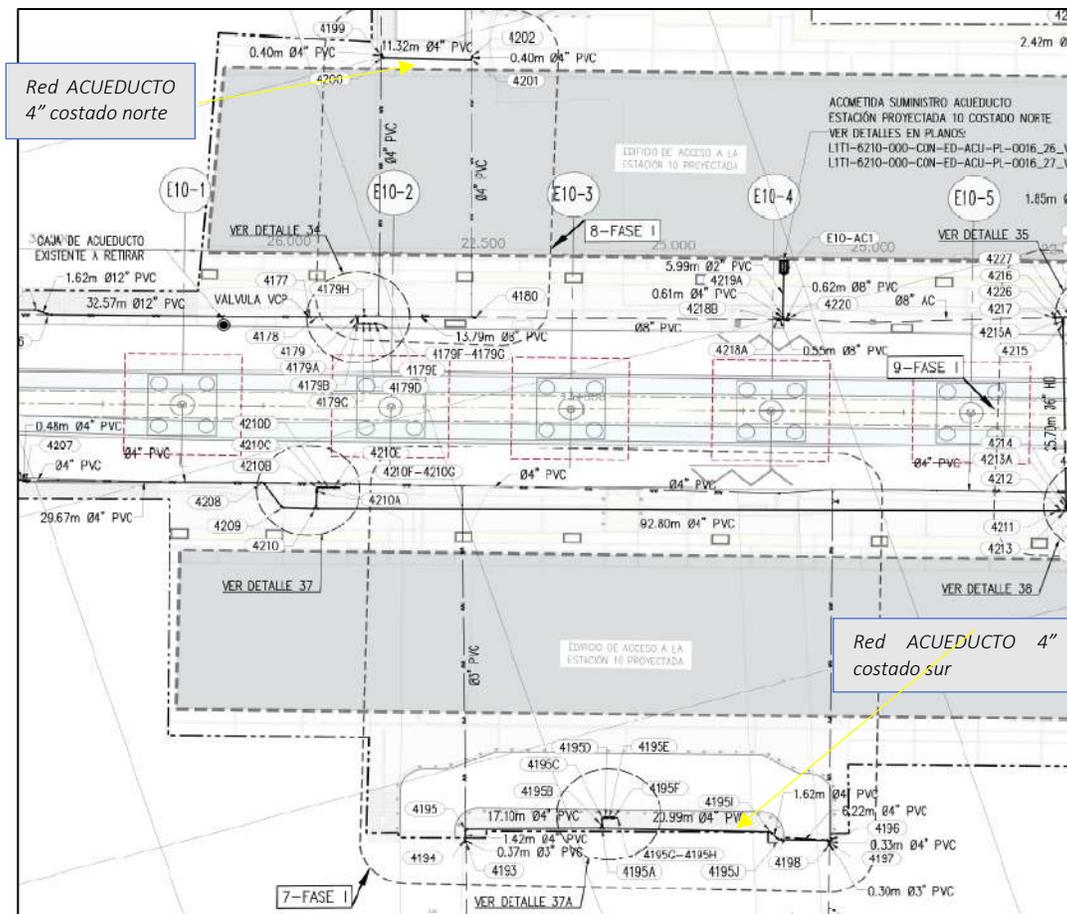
Plano de localización general de la red ACU 4-07
